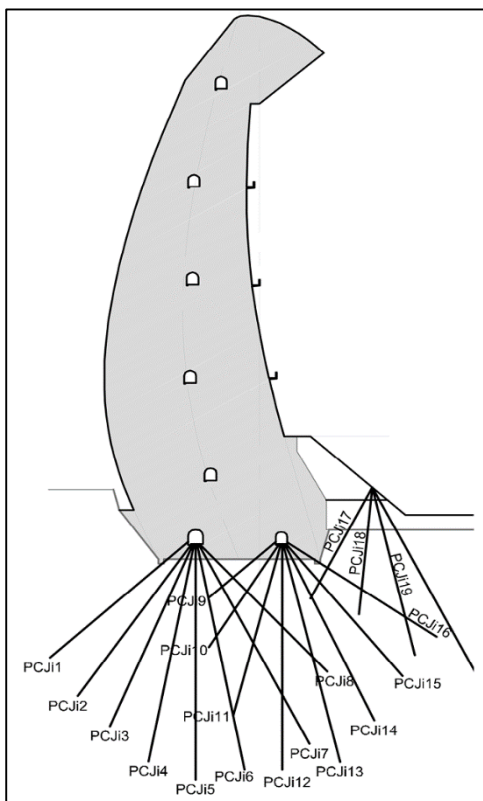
Perfil Tipo de Consolidação (Brandão, 2014)
